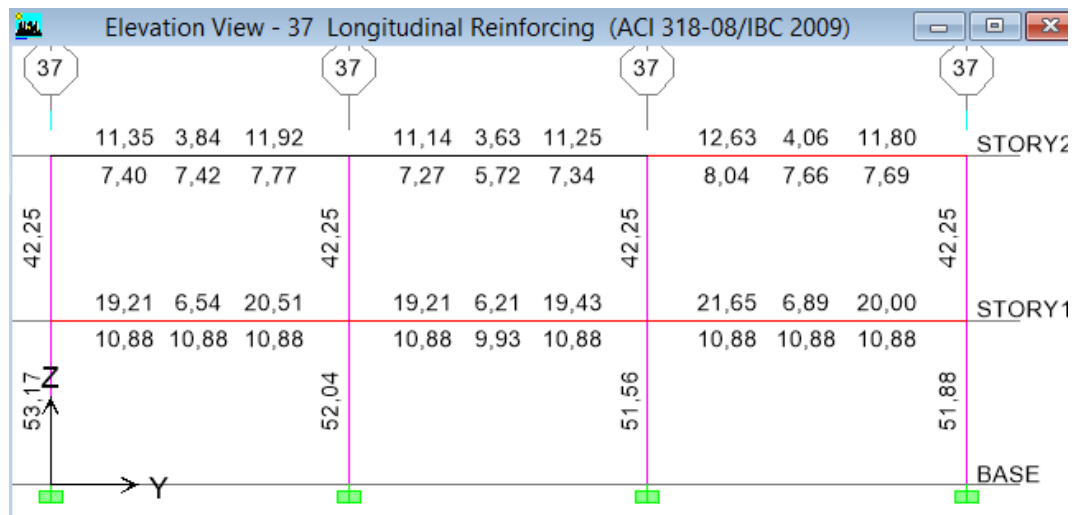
Acero en Vigas y Columnas en el Pórtico 37 – C. Quirúrgico- (NEC-11)
